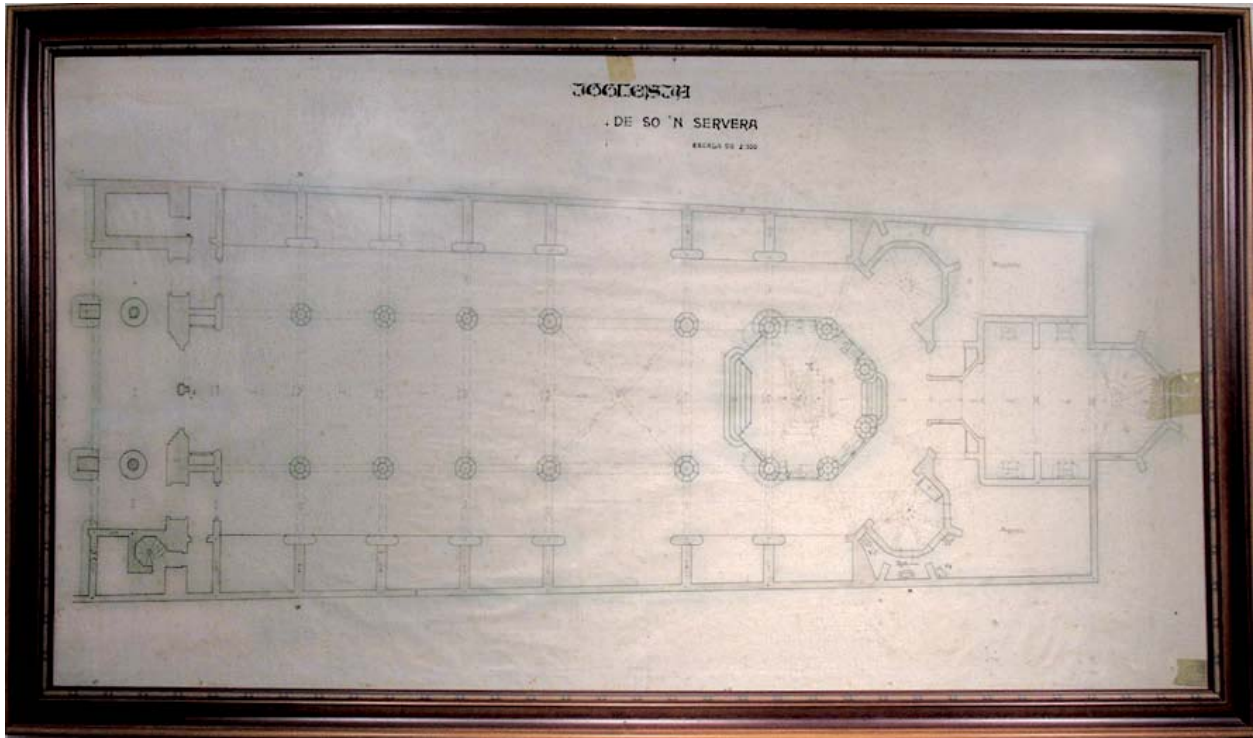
Plano de la planta de la Església Nova. Primera versió
